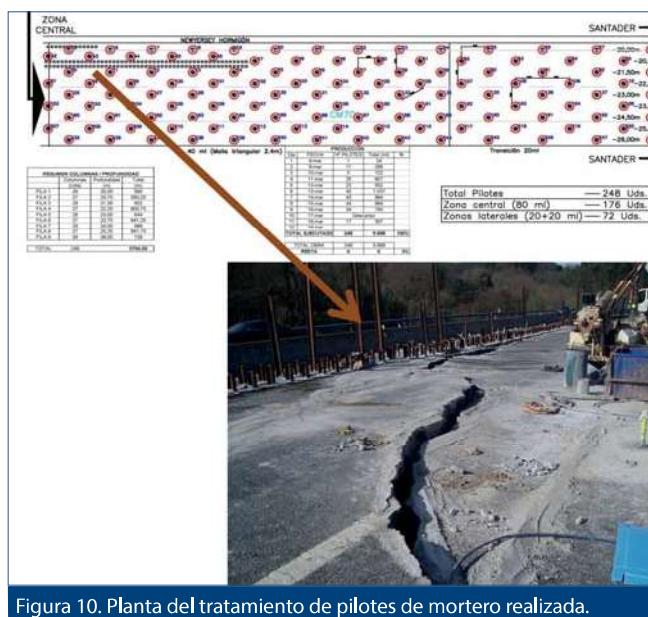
Planta del tratamiento de pilotes de mortero realizada.
